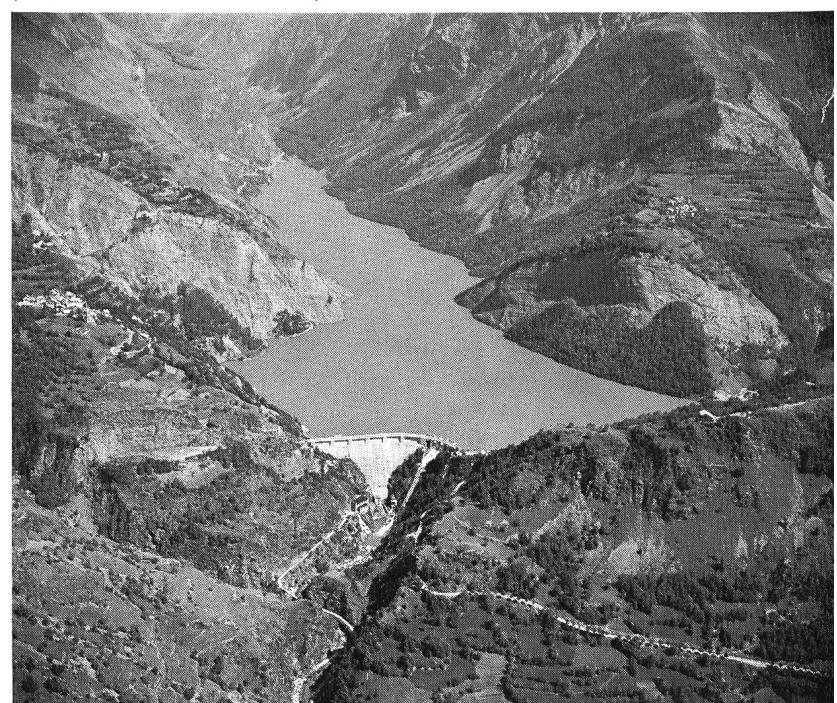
Stausee Notre Dame de Commiers (363 m) in der unteren Drac-Schlucht
